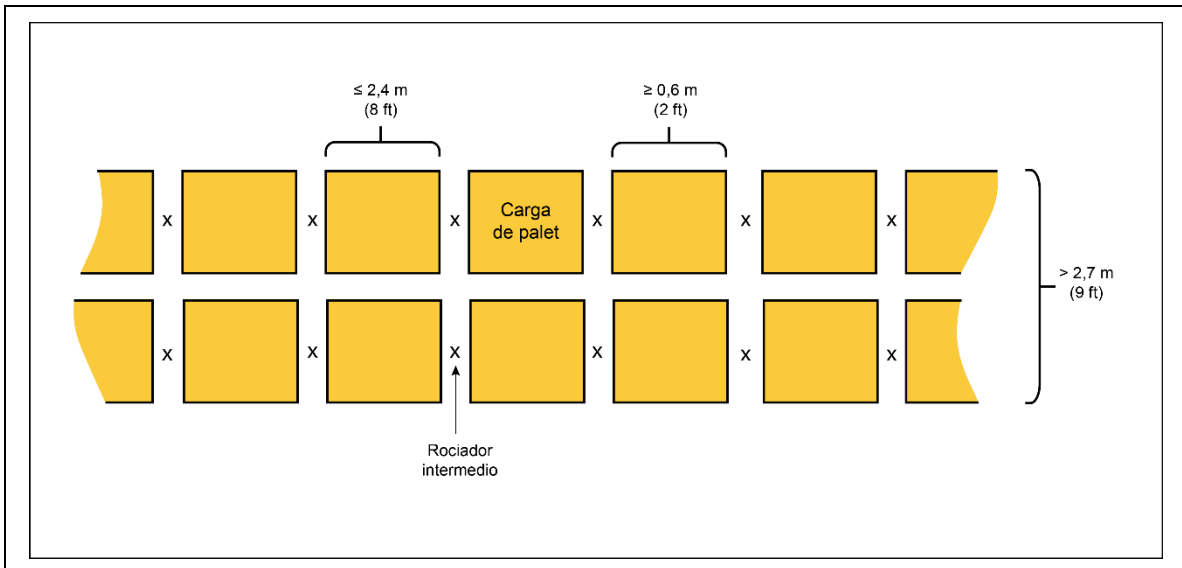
Vista en planta de una configuración horizontal de rociadores intermedios en cada chimenea transversal para estanterías dobles cuya profundidad sea superior a 2,7 m (9 ft)
